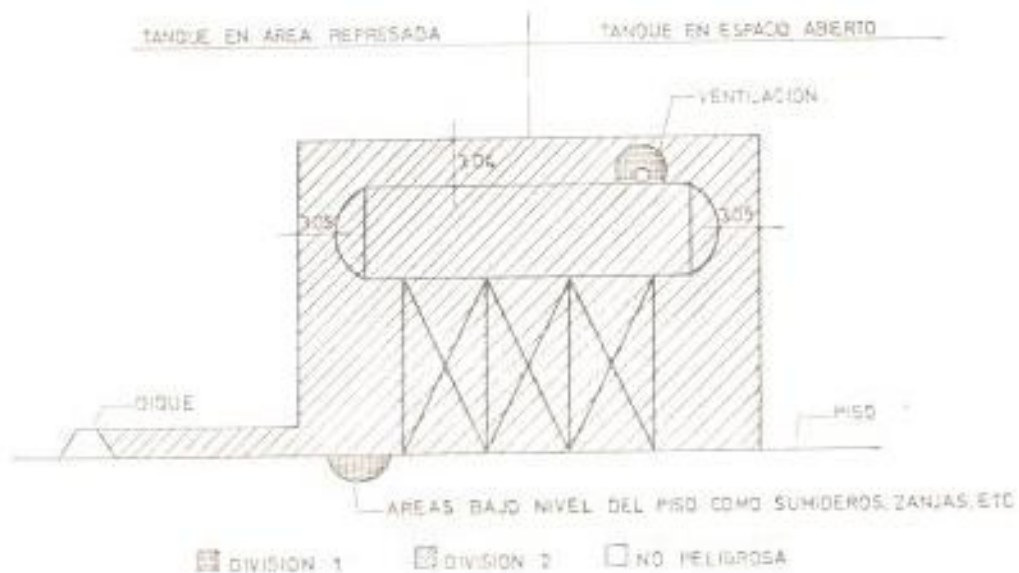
TANQUE ELEVADO PARA ALMACENAMIENTO.
